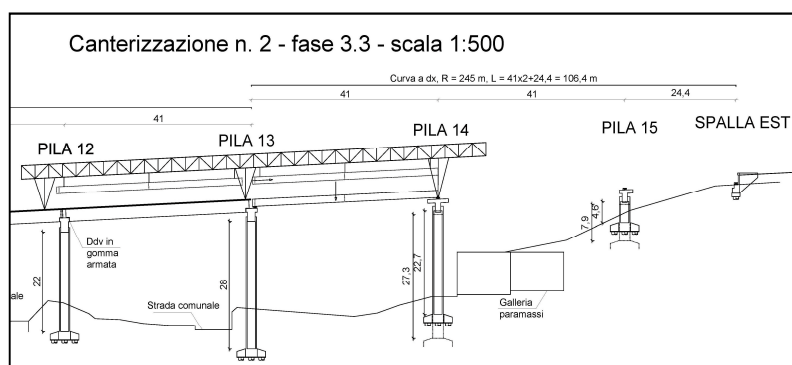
Cantierizzazione n. 2 - fase 3.3
